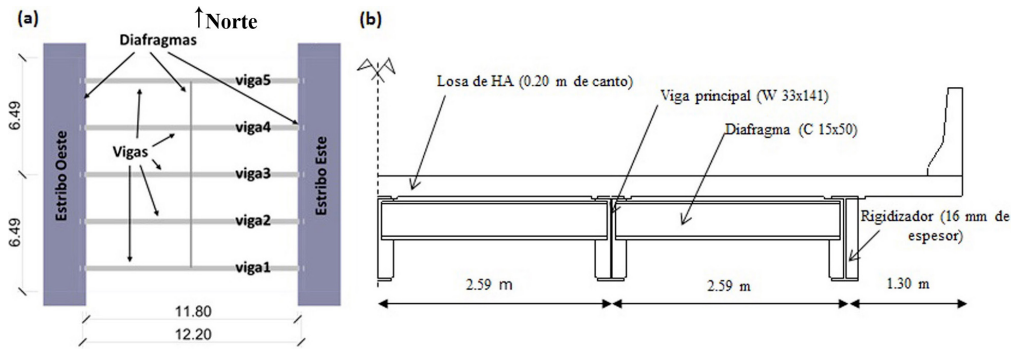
(a) Planta y (b) sección transversal del puente estudiado.
